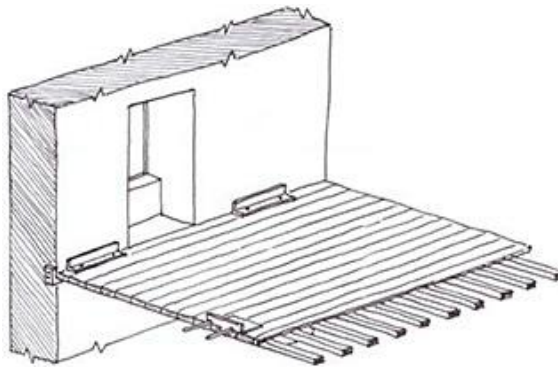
Ligação pavimento madeira e parede alvenaria
